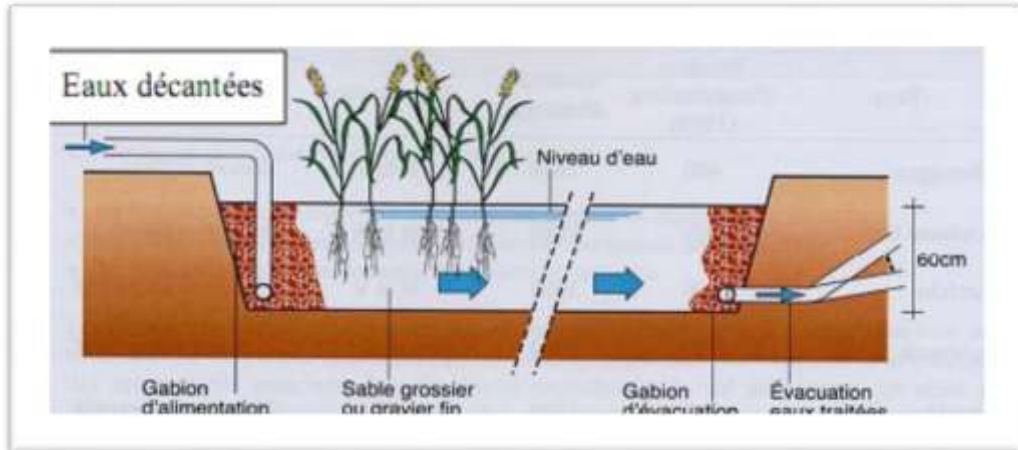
Coupe transversale schématique d'un bassin planté à écoulement horizontal (POULTE et al ,2004).
